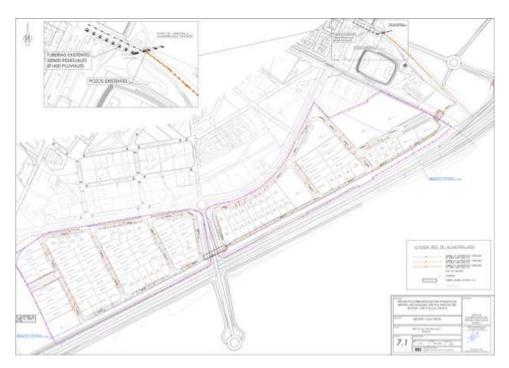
Plano de la red de alcantarillado (fuente: Proyecto)
